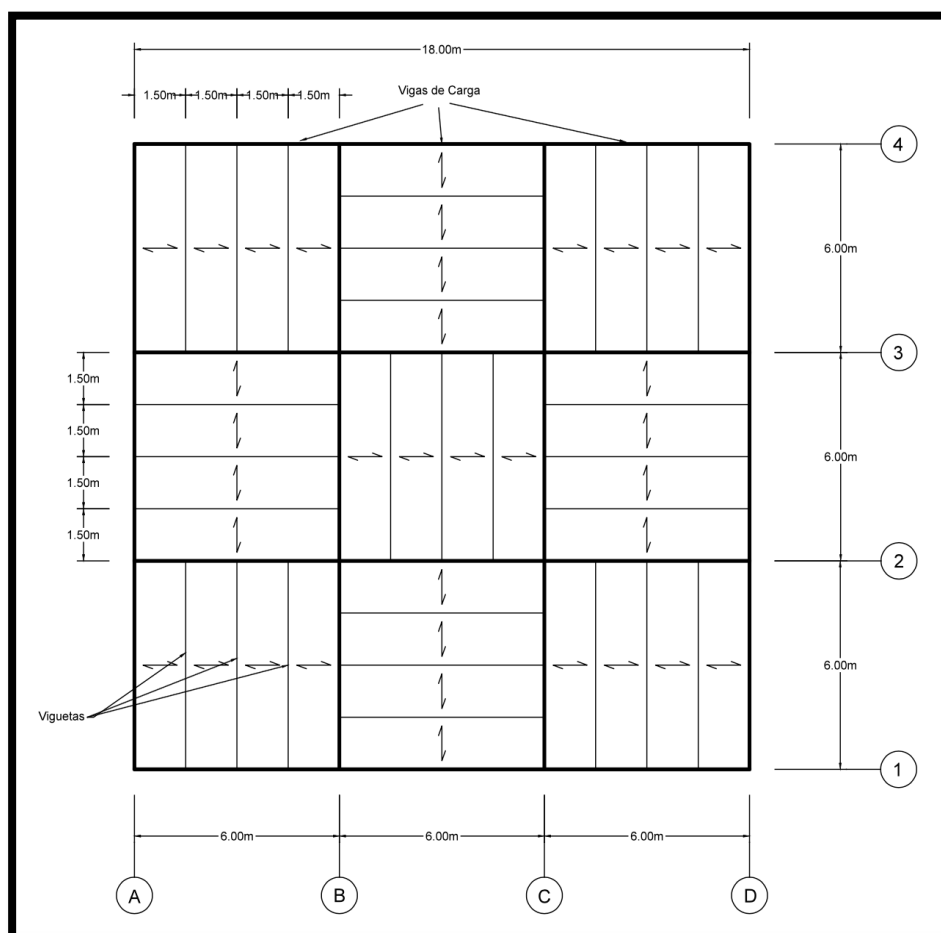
Vista en planta de la estructura. (Elaborado por el autor, 2017)
